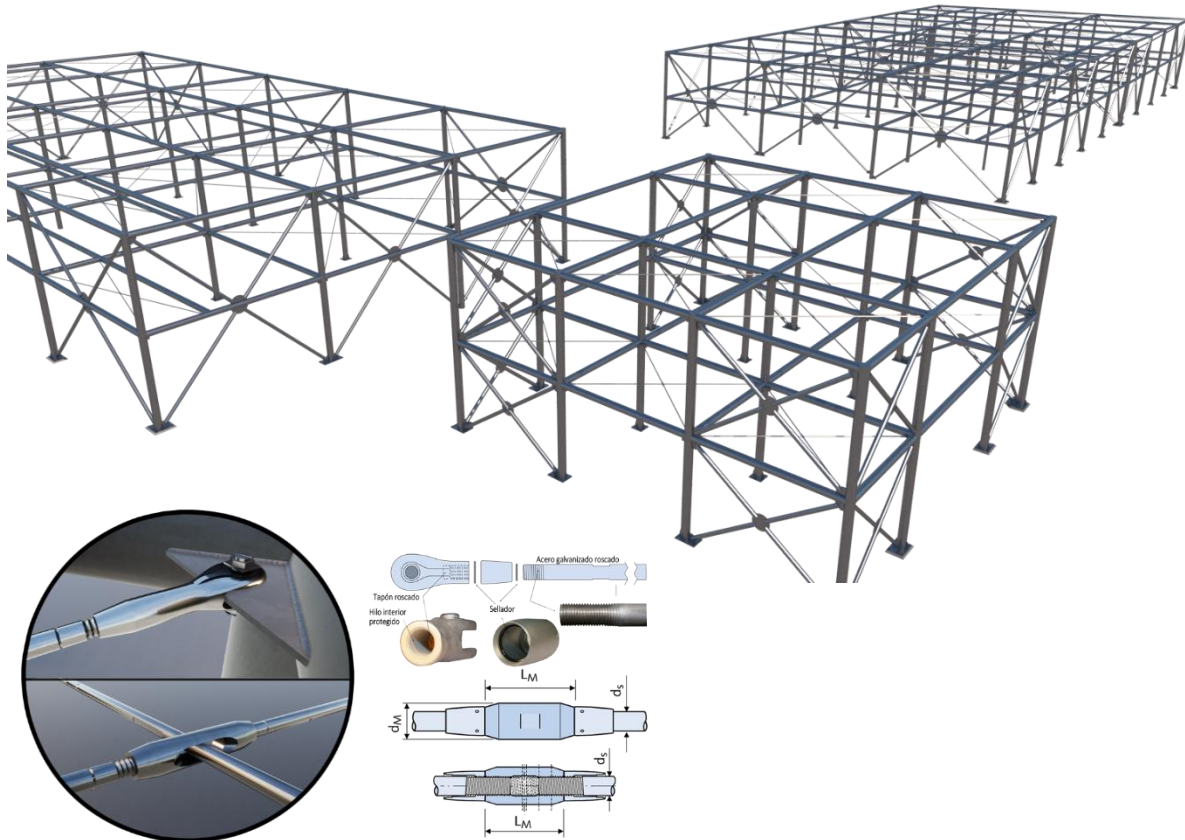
modelo en tres dimensiones de la estructura propuesta. Detalle de tensores horizontales
